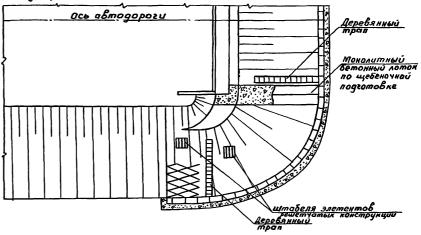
Укладка элетентов решетуатых конструкций и устрайство Бетонных лотков
